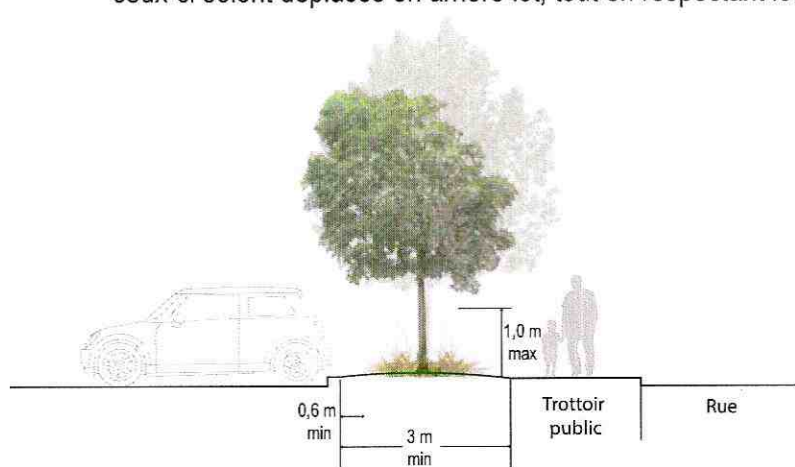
Coupe schématique d'une zone tampon entre un stationnement et une rue principale
